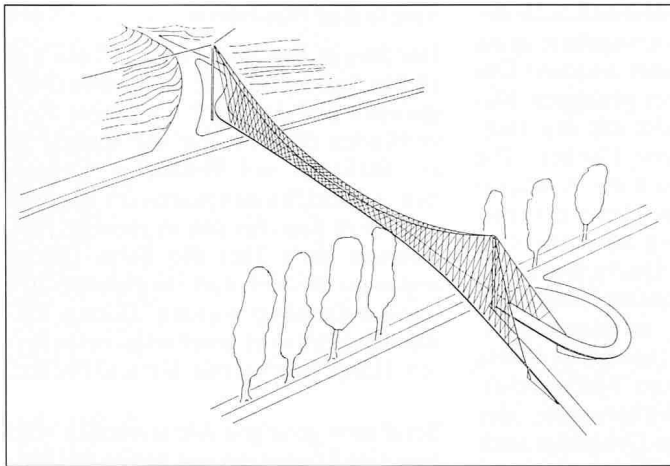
Fussgängerbrücke über den Neckar am Max-Eyth-See in Stuttgart (Baubeginn 1986) mit Architektin B. Schlaich-Peterhans
